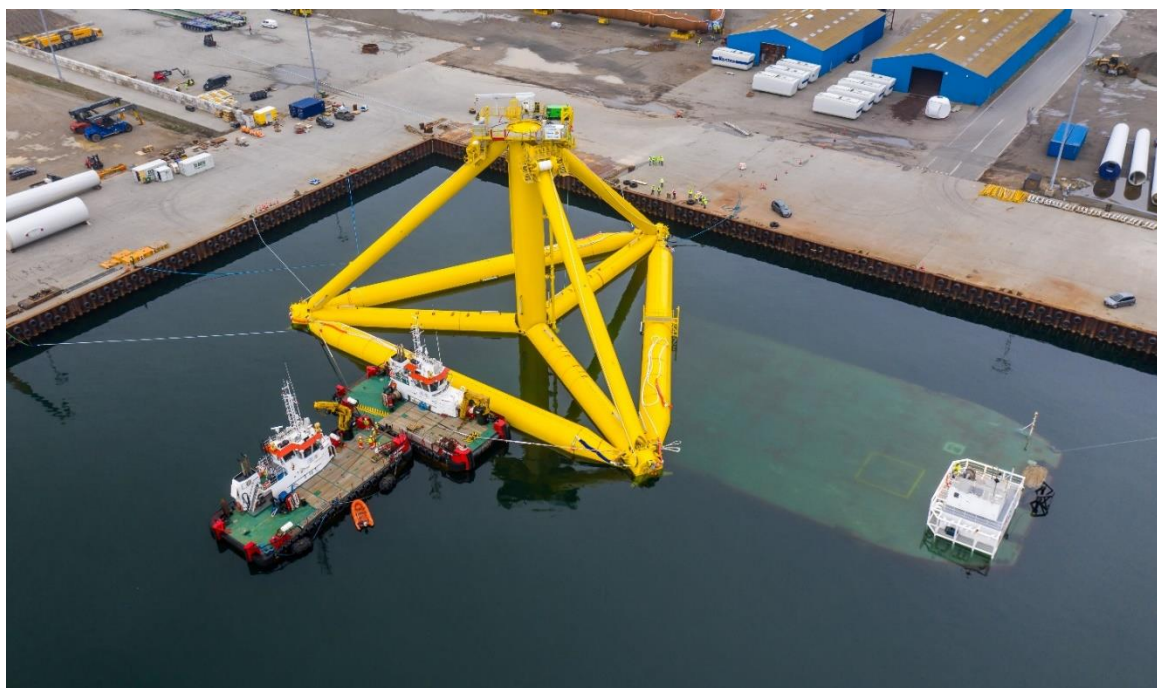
Fasi di assemblaggio della fondazione galleggiante *TetraSpar
